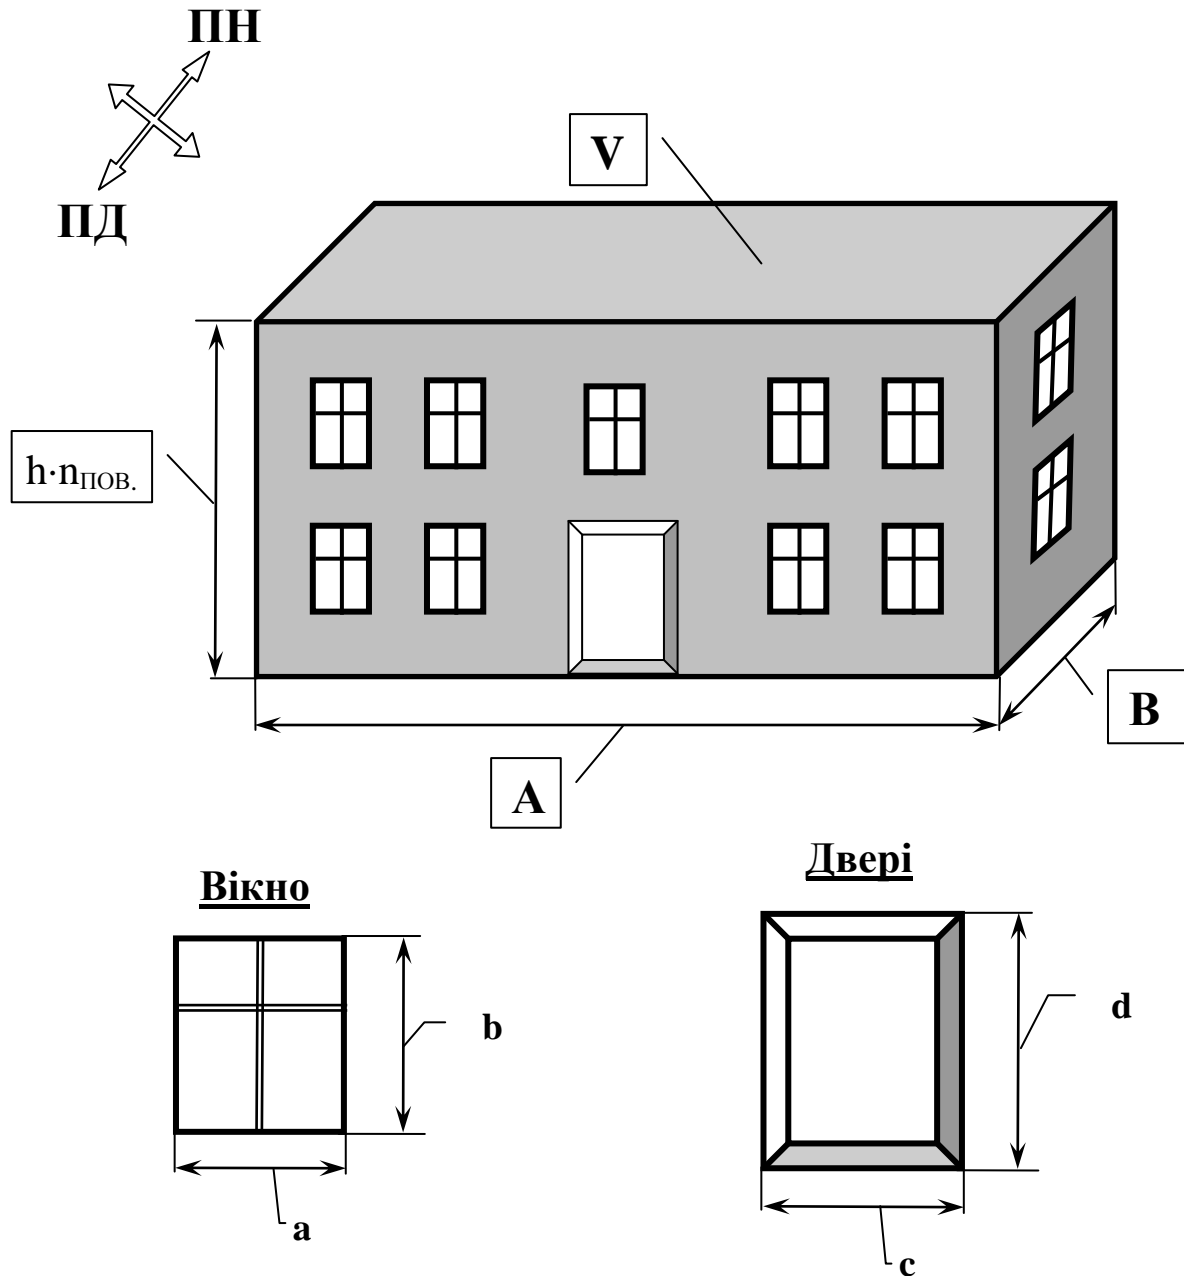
Схема будівлі дитячого садка в аксонометрії.
